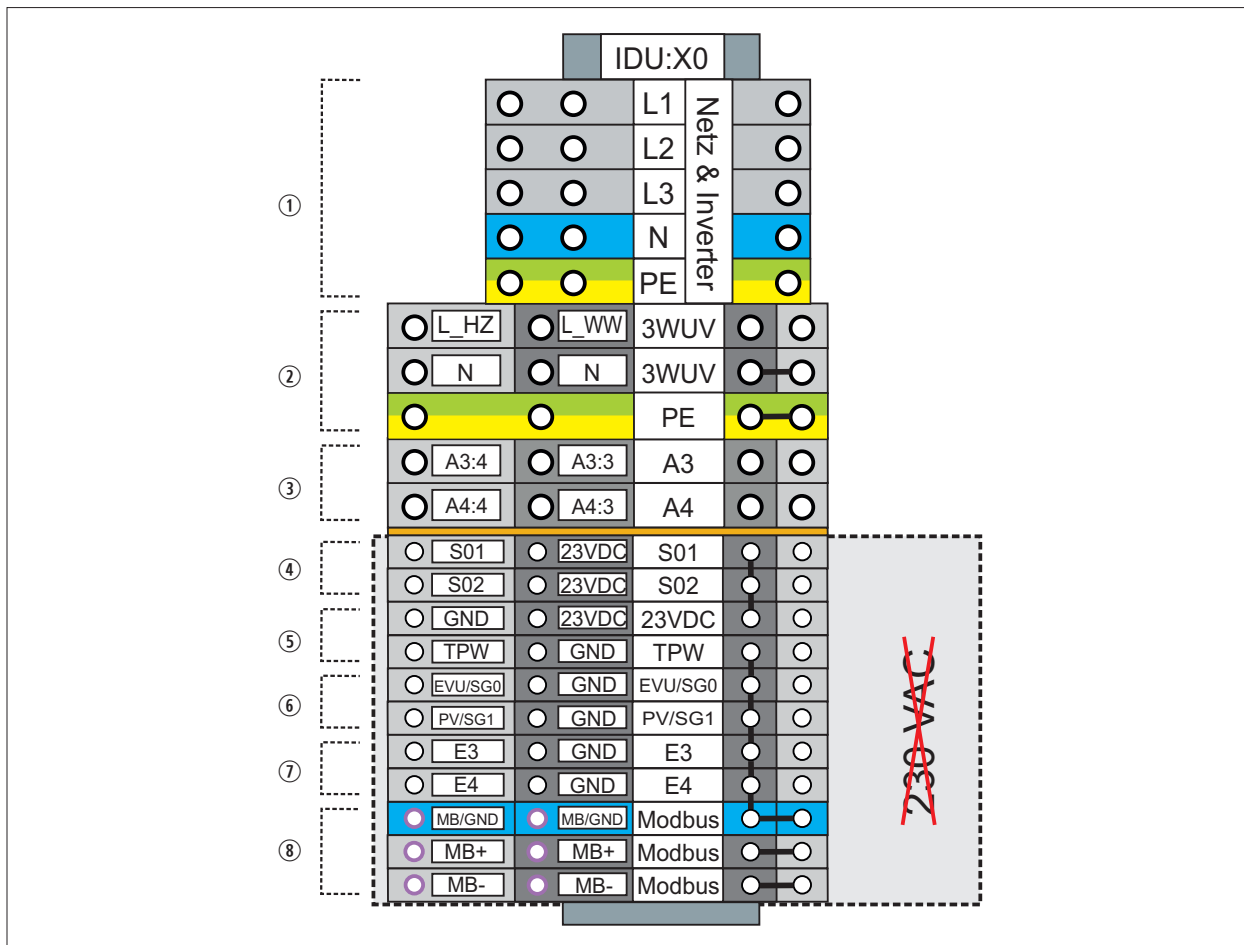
Komponenty pripájacej skrinky vnútornej jednotky
